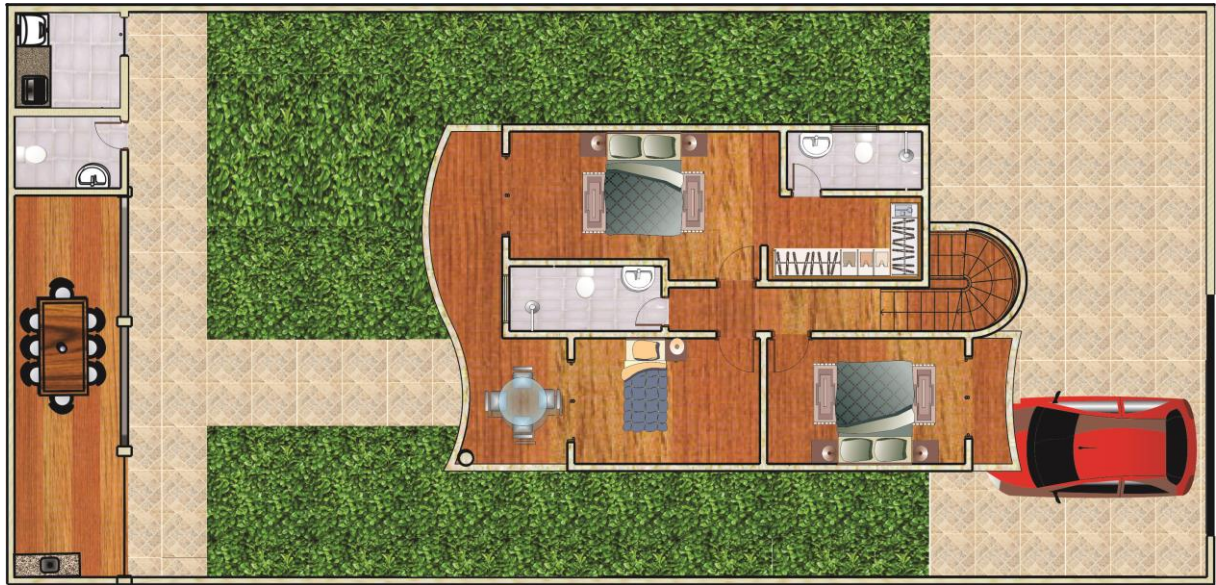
Planta Humanizada casa tipo 2 (2º Pavimento)
